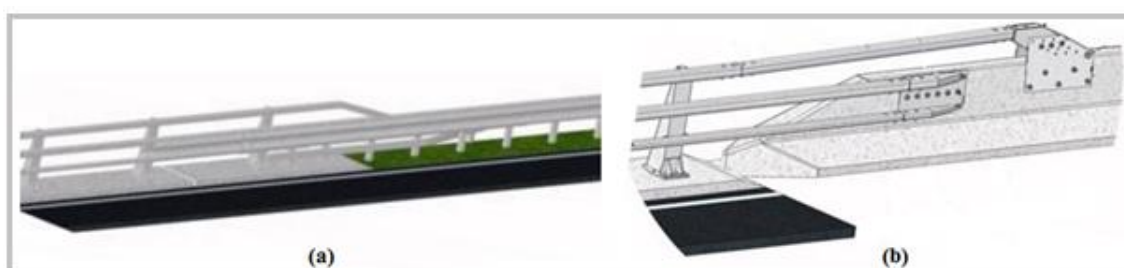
Ligação BN4: (a) guarda simples; (b) muro de contenção, catálogo fabricante [40]
